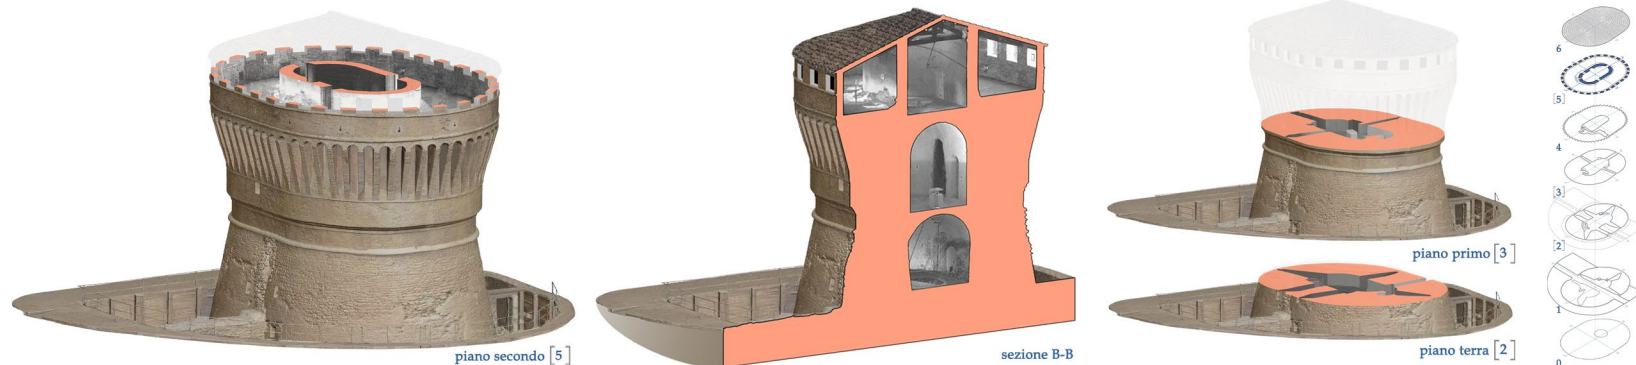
Spaccati assonometrici del modello tridimensionale, con piani di sezione orizzontali e verticali.
